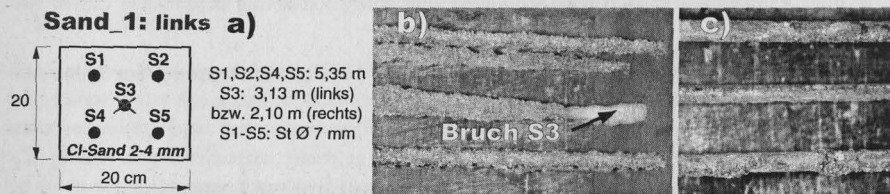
Laborversuch *Sand_1*: Im Sandbett (Körnung 2-4 mm) durch initiale NaCl- und sporadische Wasserbeaufschlagung korrodierte Spanndrähte, a): Querschnittsskizze mit Stabangaben, b): Spannstahlzustand nach 1,9 Jahren Beaufschlagung mit bis zu 4 mm dicker Korrosionsschicht sowie c): nach Grobentfernung der Korrosionsprodukte
